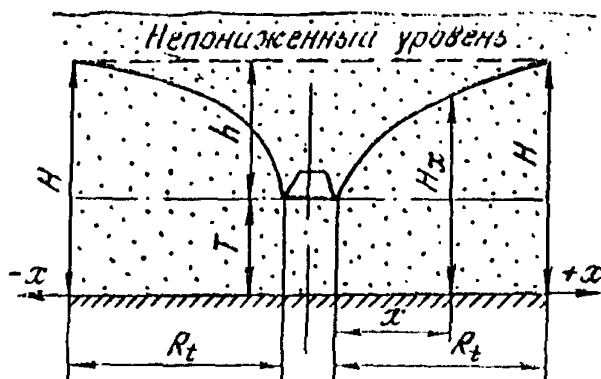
Схема к расчету длинной прямолинейной горизонтальной дрены, расположенной выше подошвы безнапорного водоносного пласта, с горизонтальной поверхностью естественных грунтовых вод.
